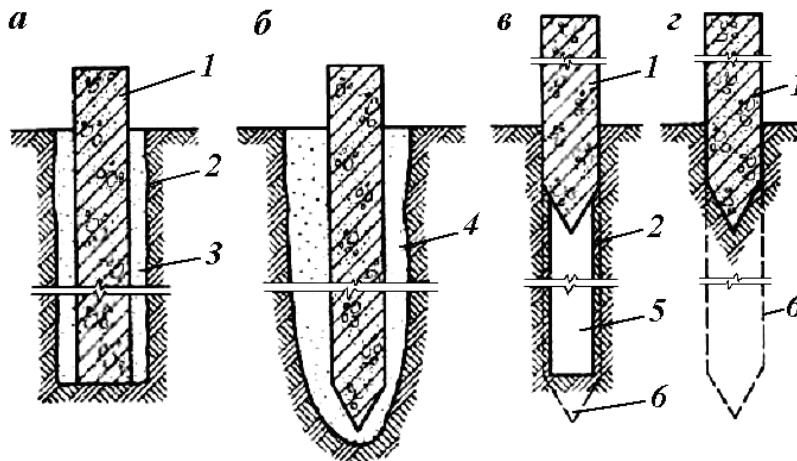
Схемы погружения свай в вечномерзлые грунты:
